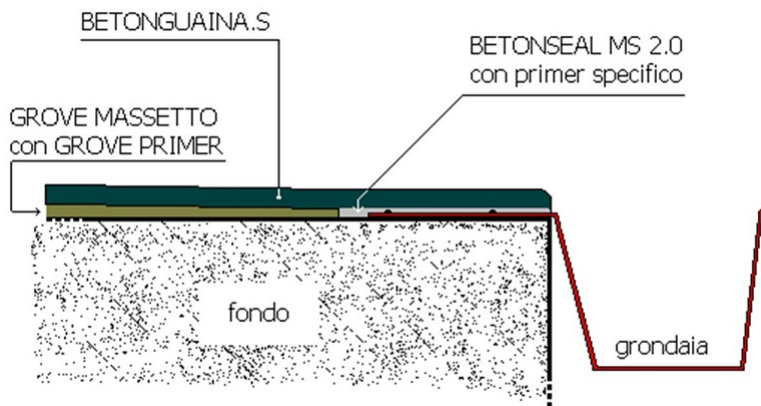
Preparazione del sottofondo con grondaie e scossaline già precedentemente posate: sigillatura e posa di BETONGUAINA.S.
